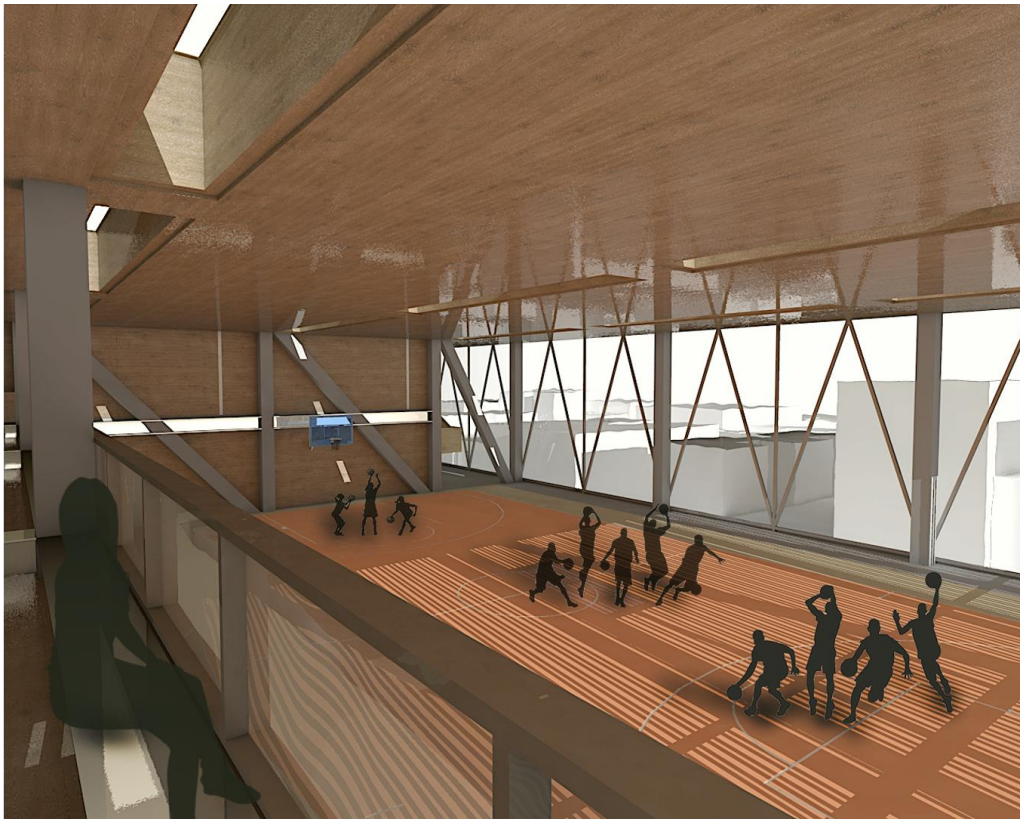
Relación fachadas y el contraste entre lo liviano y lo pesado en el Centro Cívico Policarpa, 2021, imagen render arquitectónico. Elaboración propia.
